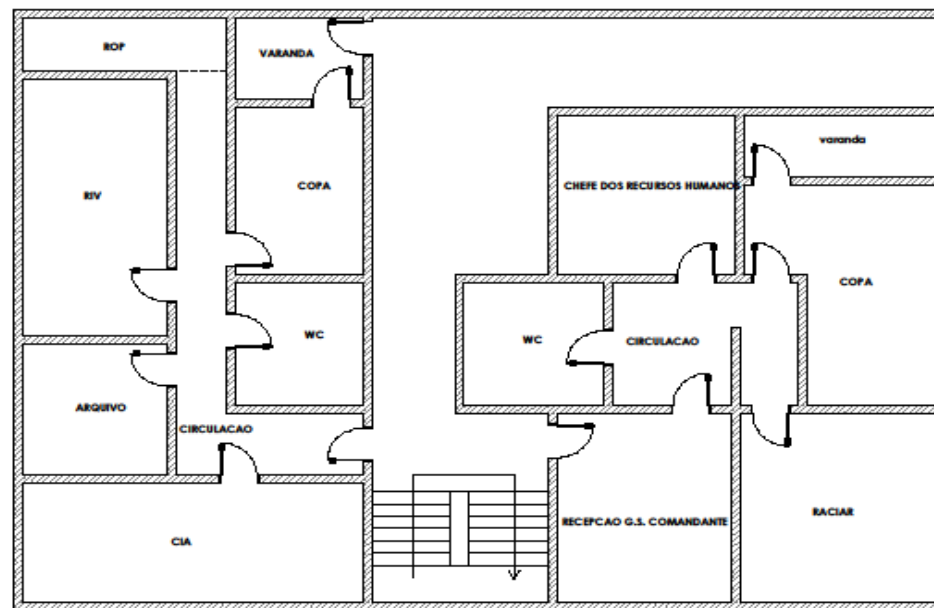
Planta ilustrativa do 1º Andar (Pavimento 1)
